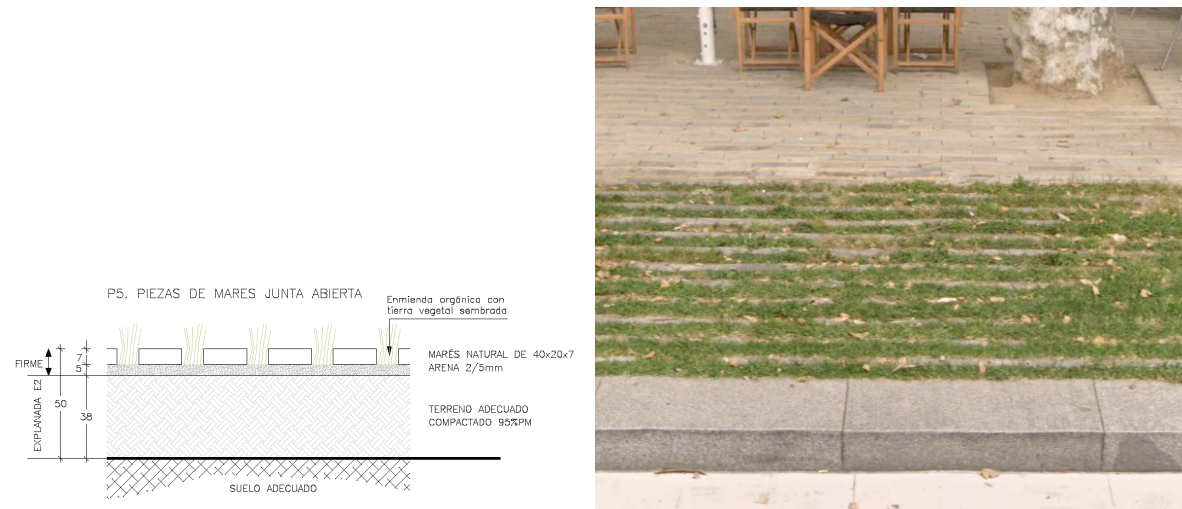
Sección constructiva del pavimento P5 e imagen de referencia.
